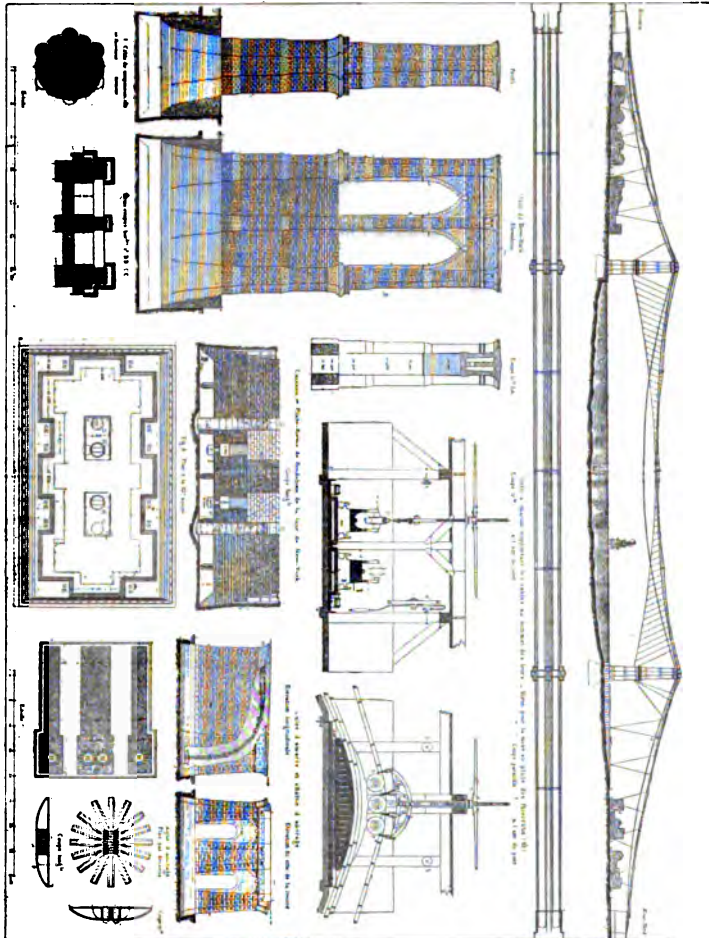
à 117. — Pont de Brooklyn, sur l'East-River. — Détails de Construction.
